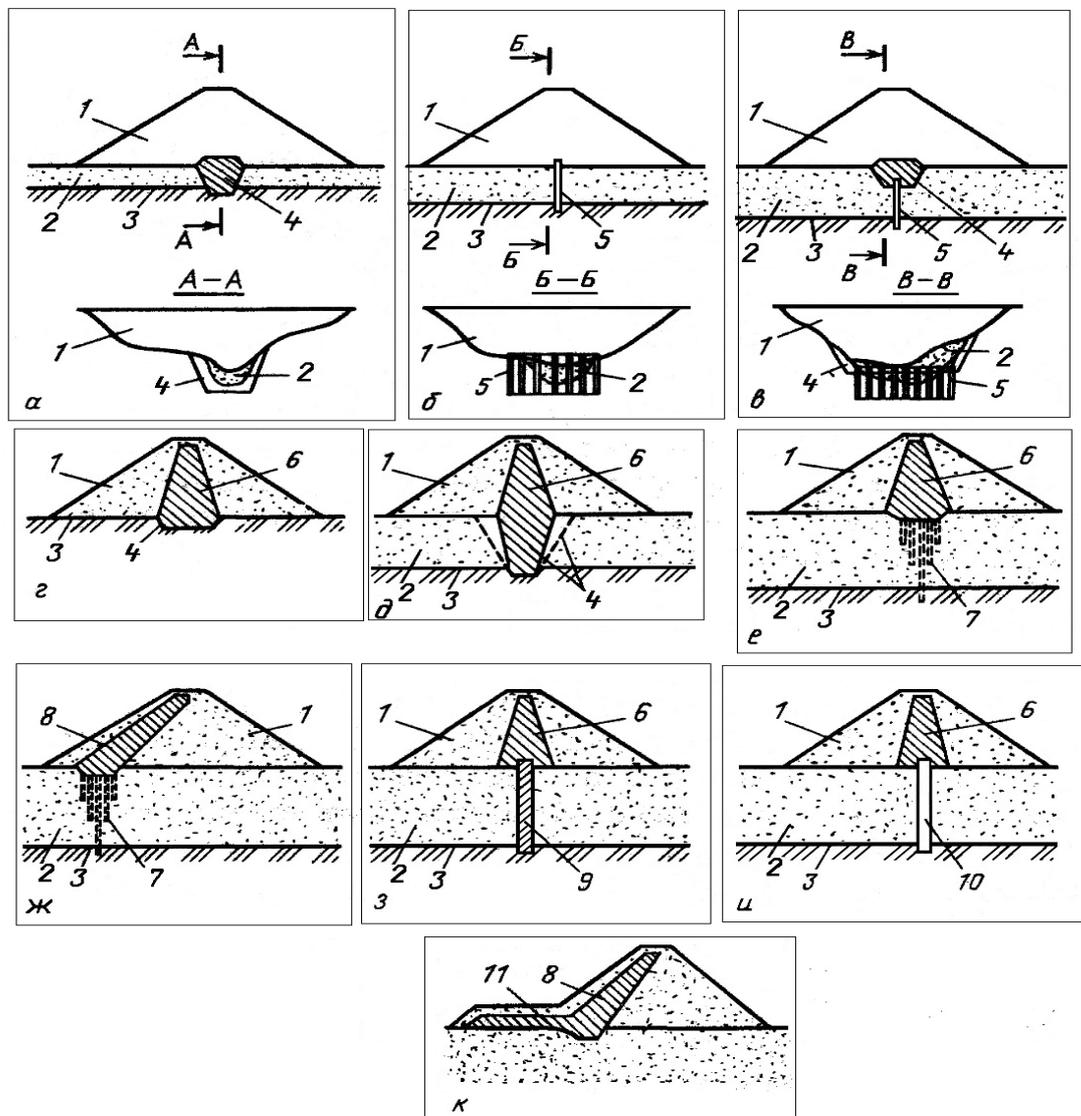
Схемы ПФУ в проницаемых нескальных основаниях: а – зуб; б – шпунт; в – зуб и шпунт; г – ядро с неглубоким зубом; д – ядро и глубокий зуб; е и ж – инъекционная завеса в сочетании с ядром и экраном; з – траншейная стенка; и – буробетонная стенка; к – экран с понуром; 1 – тело плотины; 2 – проницаемое основание; 3 – водоупор; 4 – зуб; 5 – шпунт; 6 – ядро; 7 – инъекционная завеса; 8 – экран; 9 – траншейная стенка; 10 – буробетонная стенка; 11 – понур
